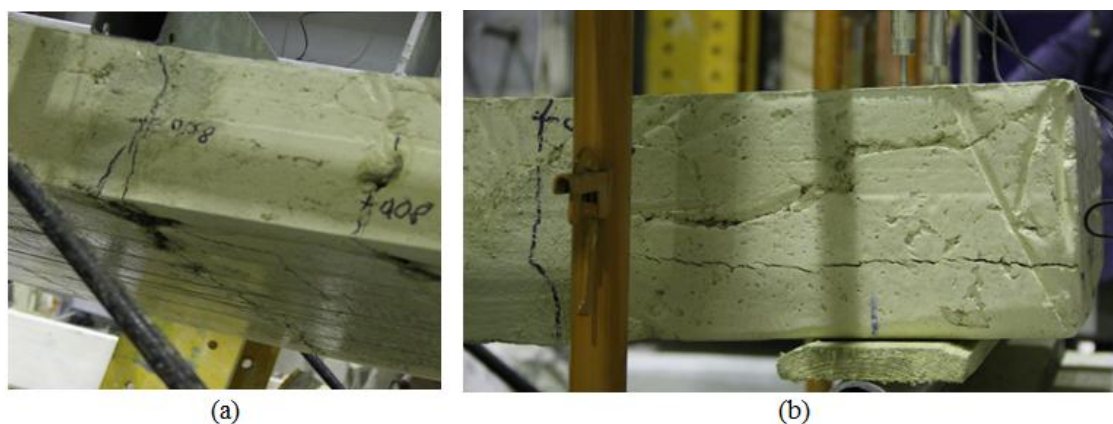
Laje *L3*: a) – aumento de abertura de fissura vertical na secção 2, b) – surgimento de fissura longitudinal na zona de apoio da secção 1.
